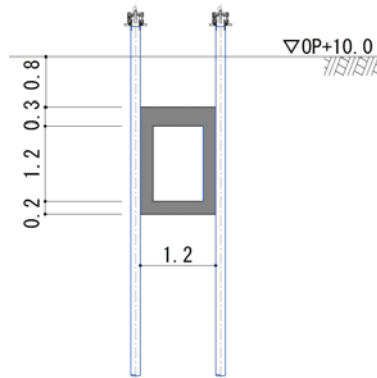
【3-1】排水ヒューム管① 施工方法（複列施工）
